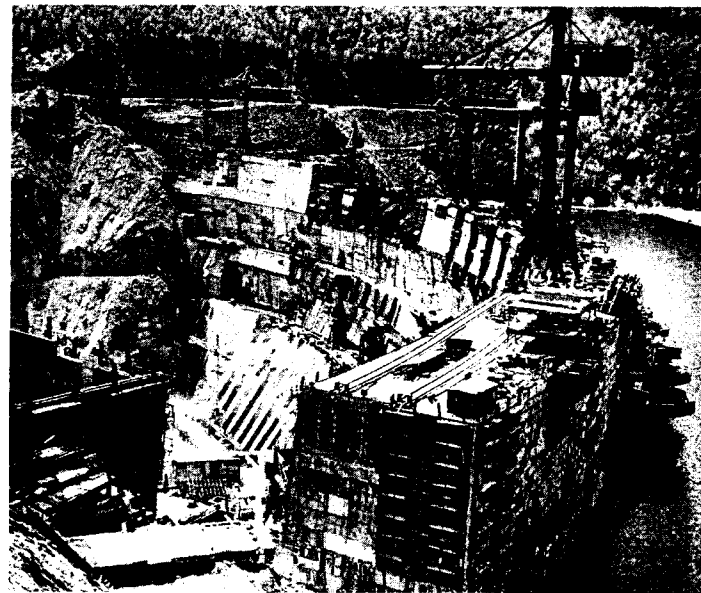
Бетонирование Саяно-Шушенской ГЭС кранами КБГС-1000 без эстакад
